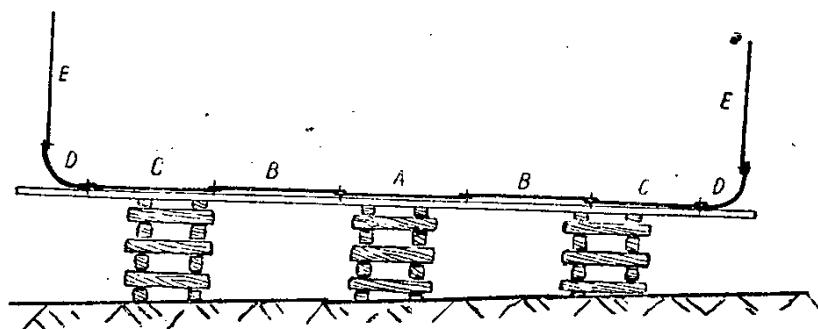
Konstrukce s outorem (trapezem) zevním.
